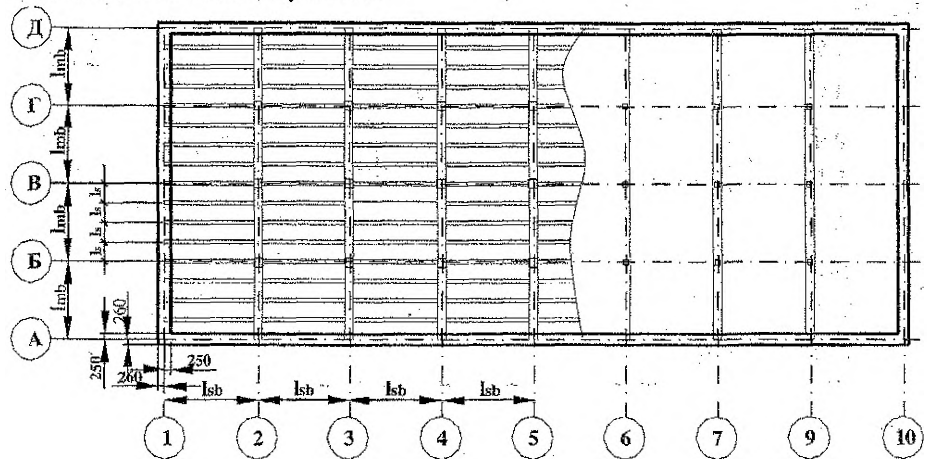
К назначению размеров пролетов и поперечных сечений элементов перекрытия.
